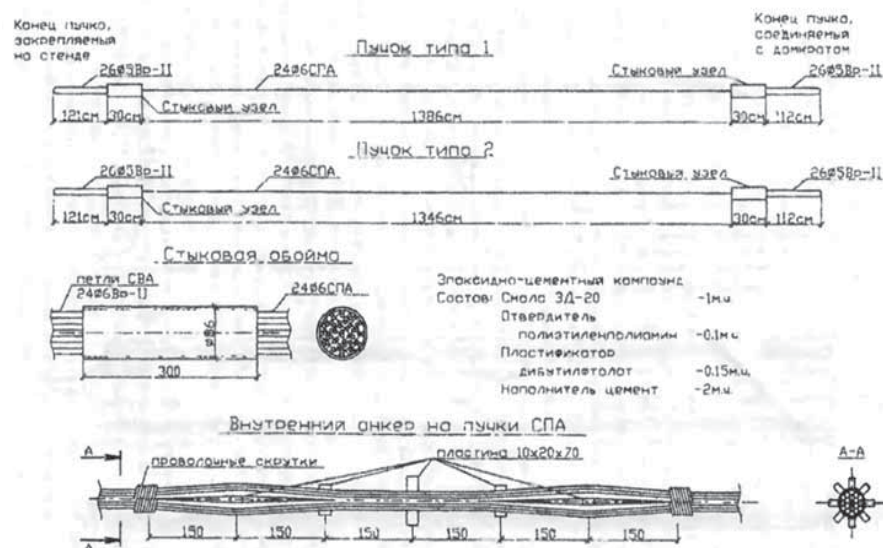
Конструкция пучков из напрягаемой арматуры для опытных балок длиной 15 м
